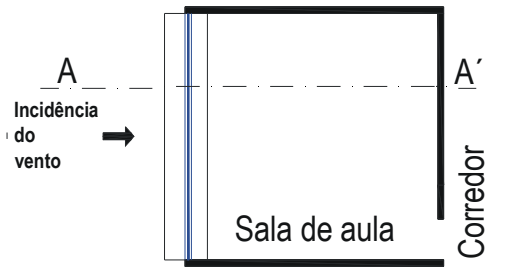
Planta baixa da sala com peitoril ventilado curvo
